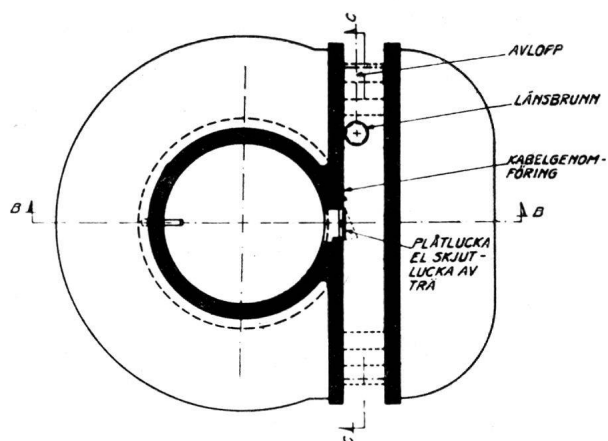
Grundriss A-A. Avlopp = Ablauf, länsbrunn = Entleerungsschacht, kabelgenomföring = Kabeleinführung, Plåtlucka al. skjutlucka av trä = Bleiklappe oder Schliessluke aus Holz.
